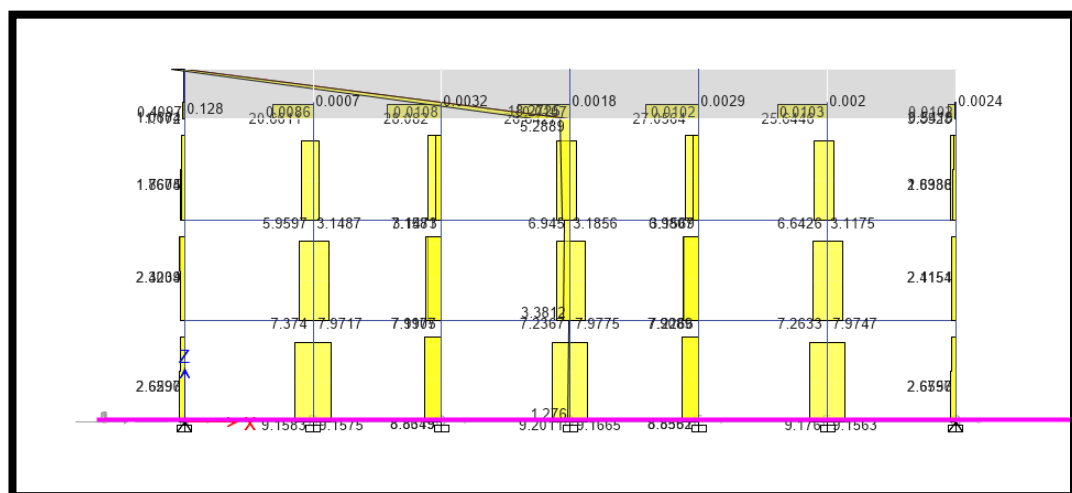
Corte de Sección (Section Cut) para la Dirección X.
